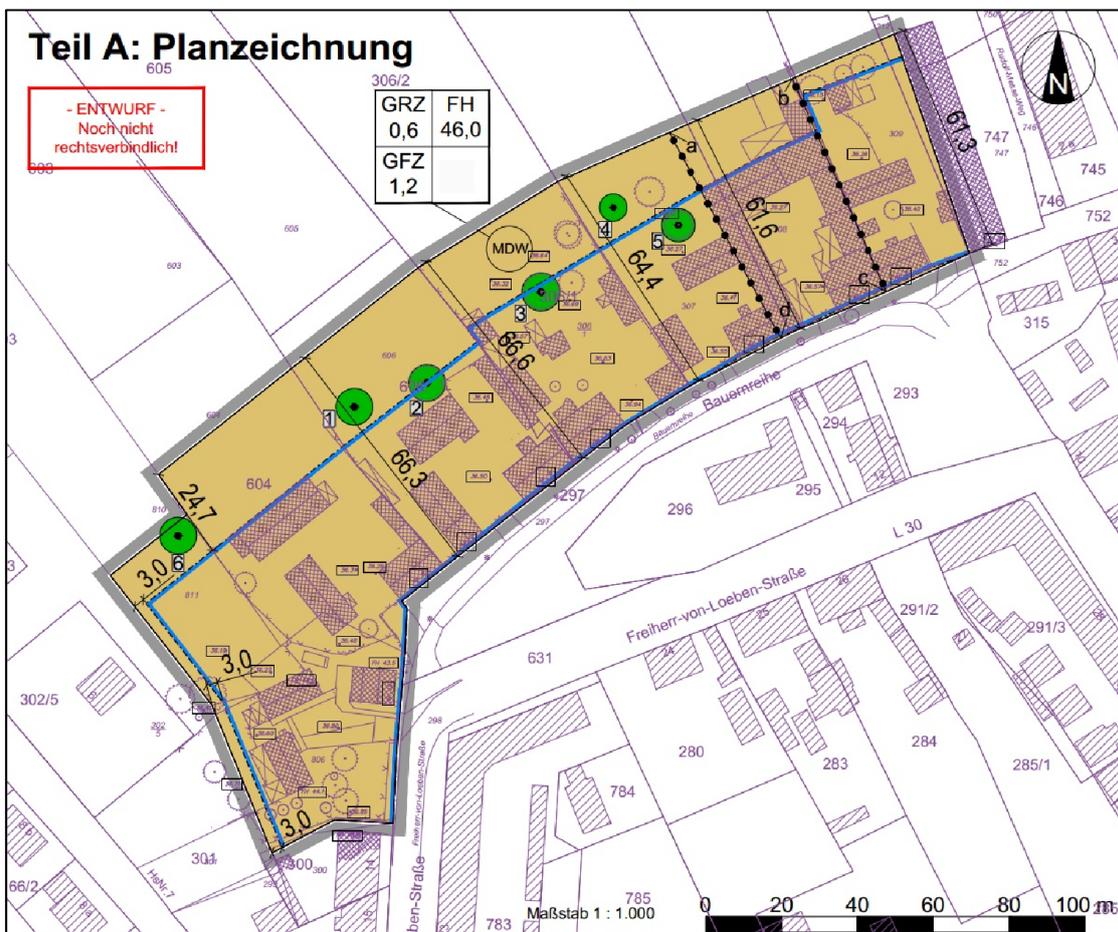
Ausschnitt aus der Planurkunde zum Bebauungsplan (April 2022)
